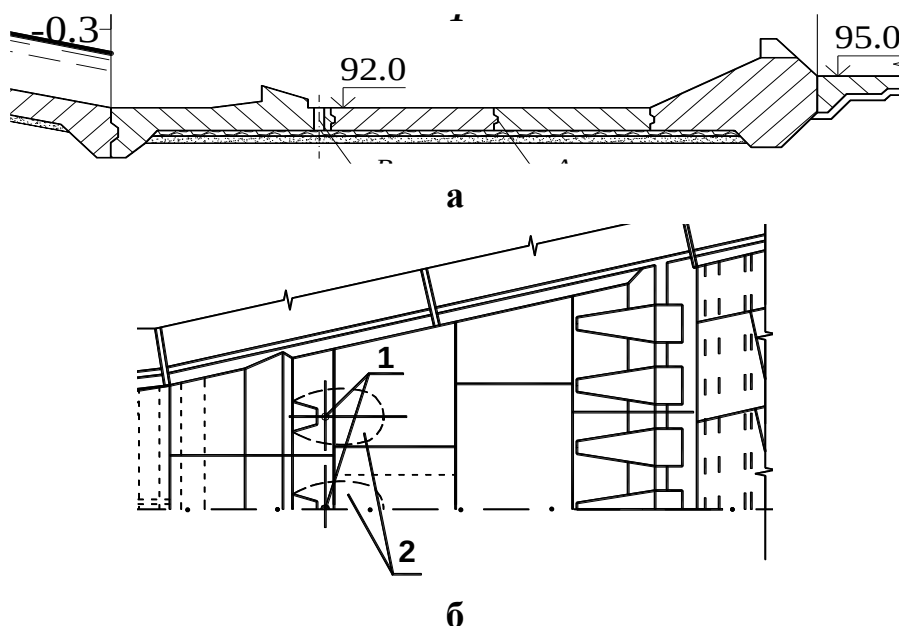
Продольный разрез (а) и план (б) гасителей на раструбе водобоя с указанием рекомендуемых мест устройства дренажных колодцев специальной конструкции (1, 2)
